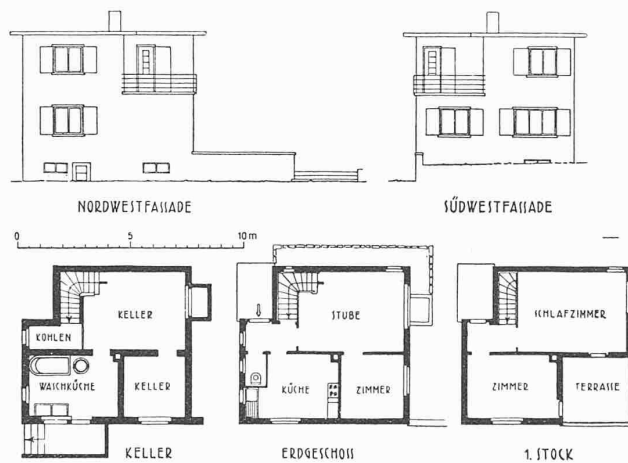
Grundrisse und Fassaden, Masstab 1 : 300.
